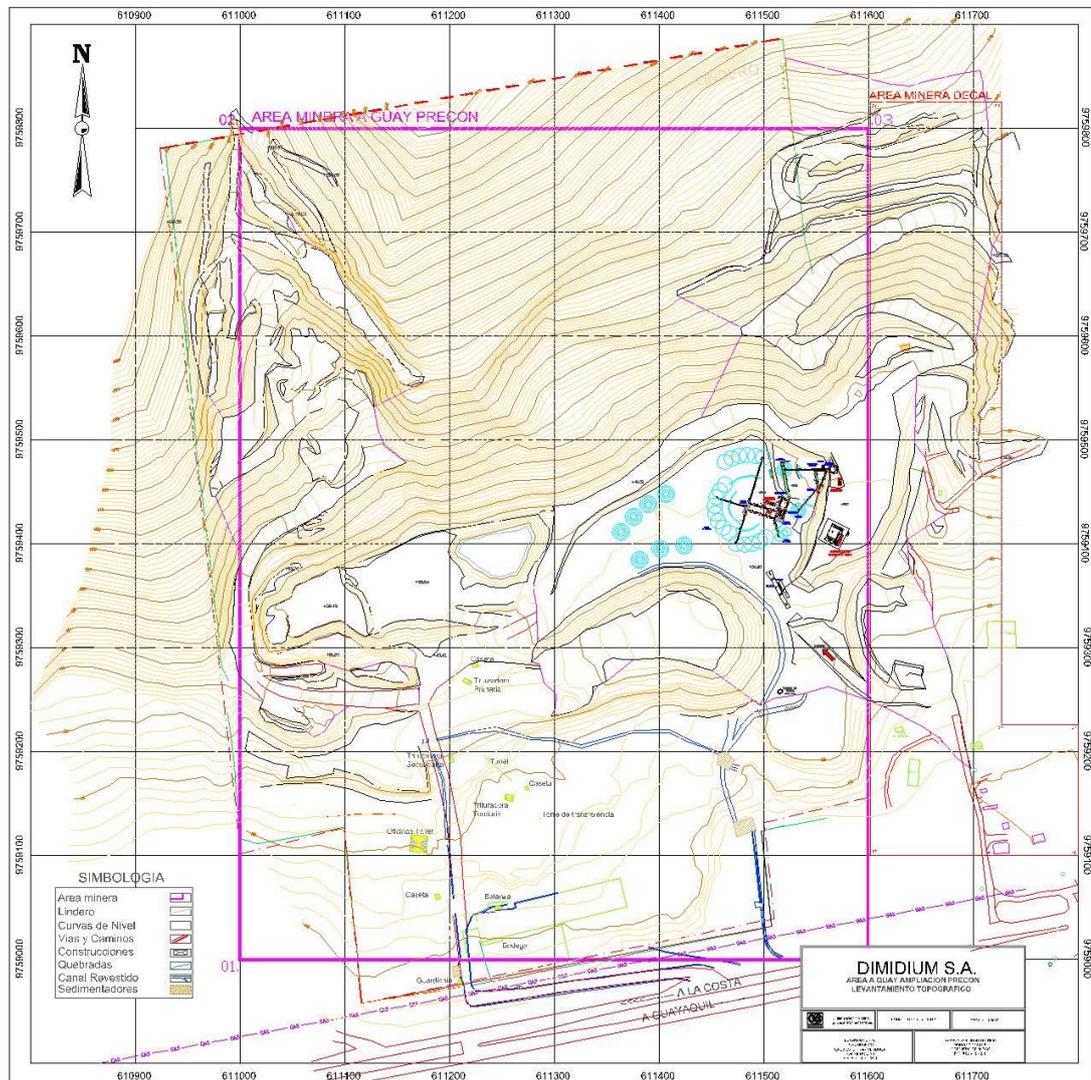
Plano topográfico con implantación de Planta.
